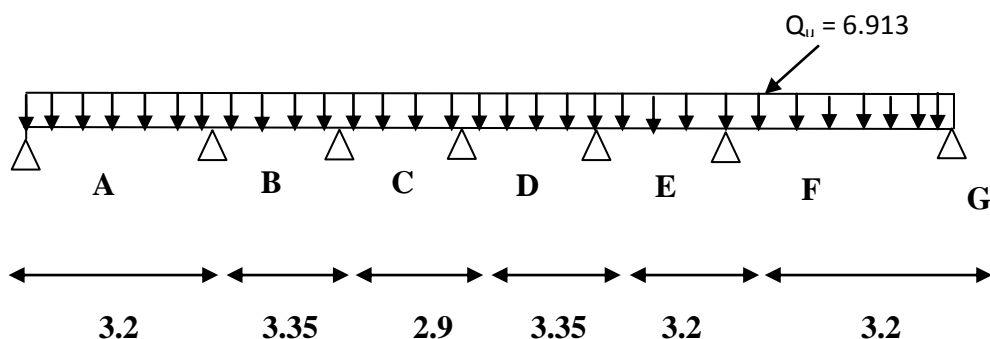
Schéma statique de calcul du 1er type de poutrelles
